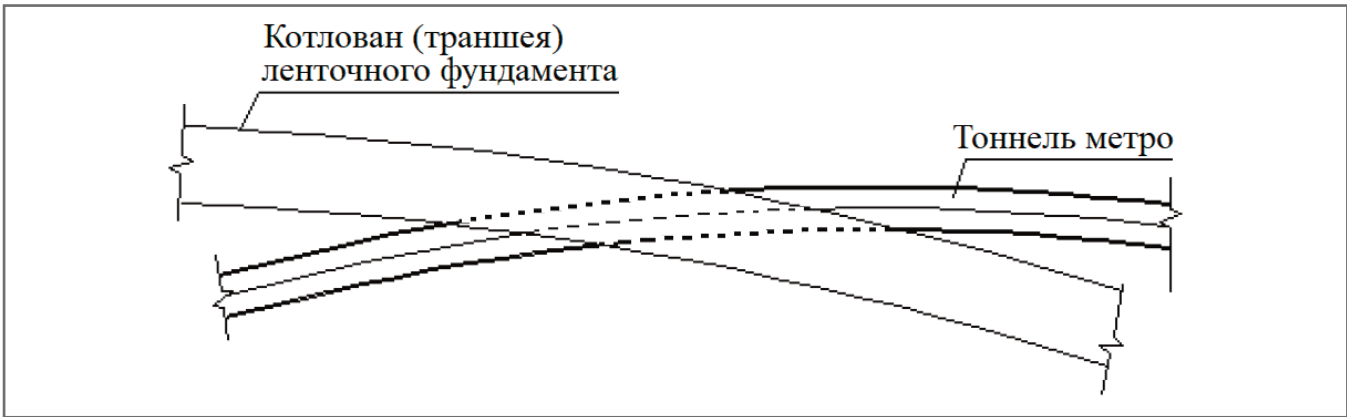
Схема расположения тоннеля метро и котлована друг относительно друга в плане
